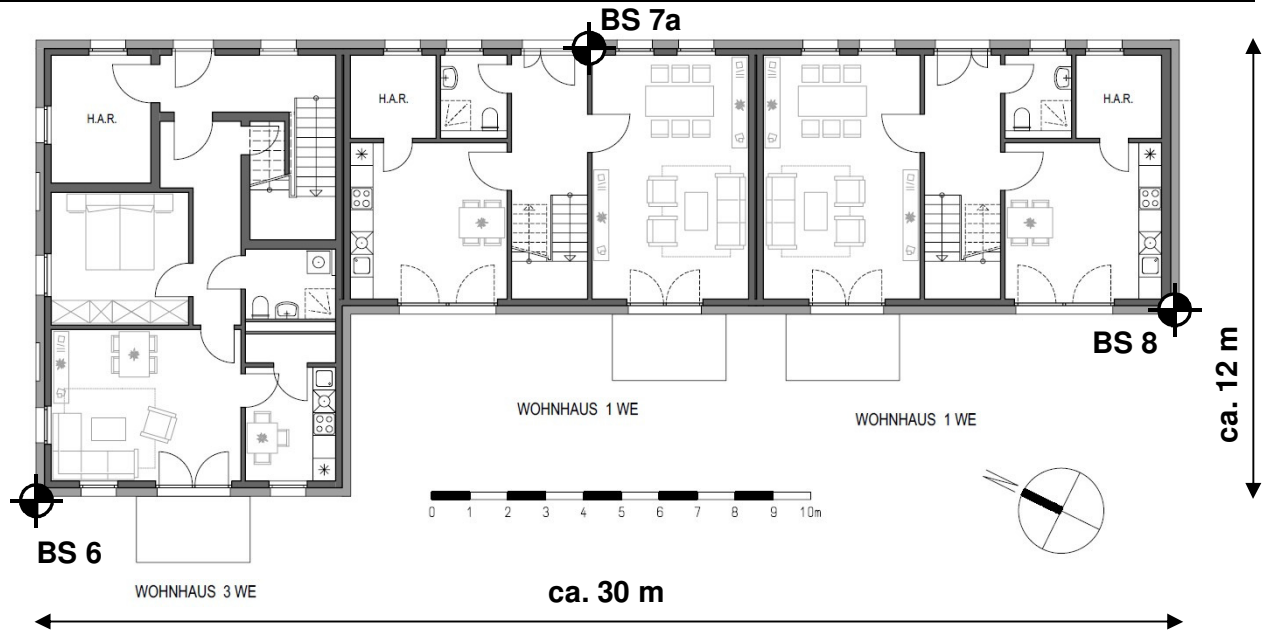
Erdgeschossgrundriss Haus 5, M 1:200
